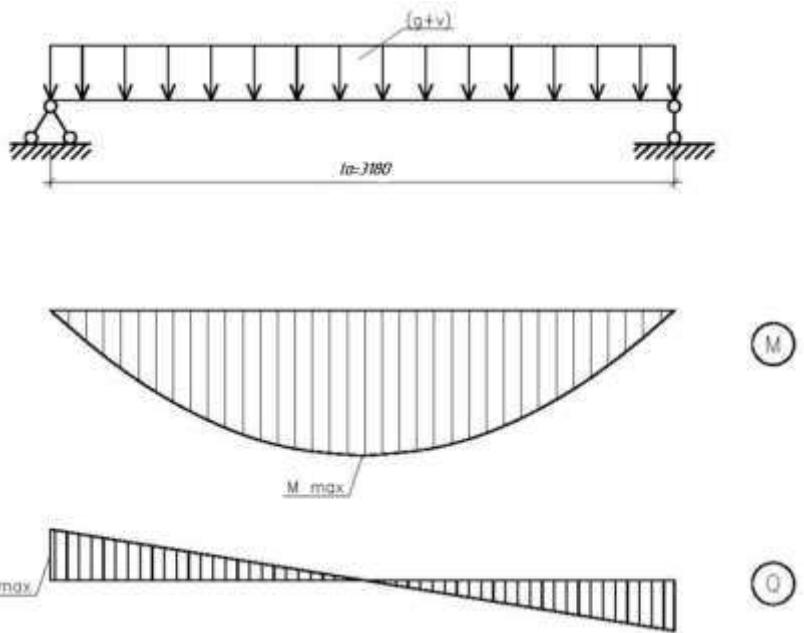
Расчётная схема плиты и эпюры усилий
